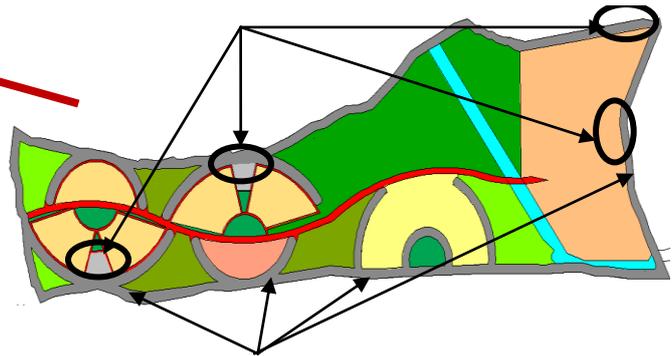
parkings des voitures dans le plan de masse (source : auteur)
